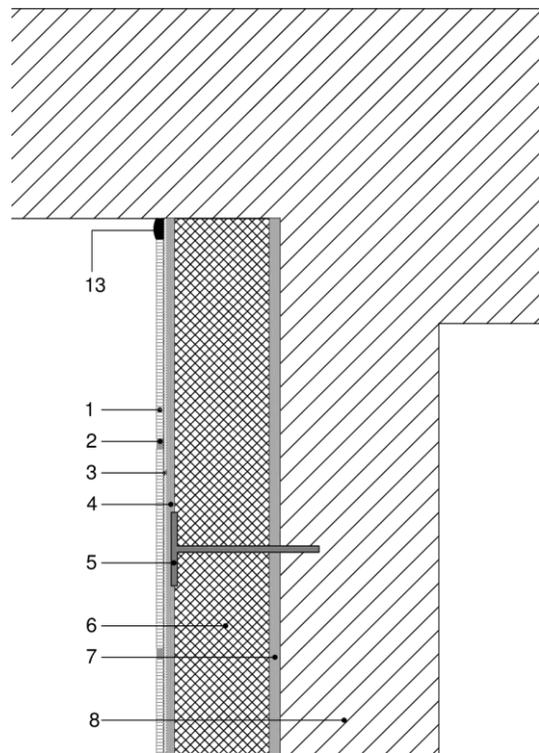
Coronación. Encuentro con cubierta plana.
